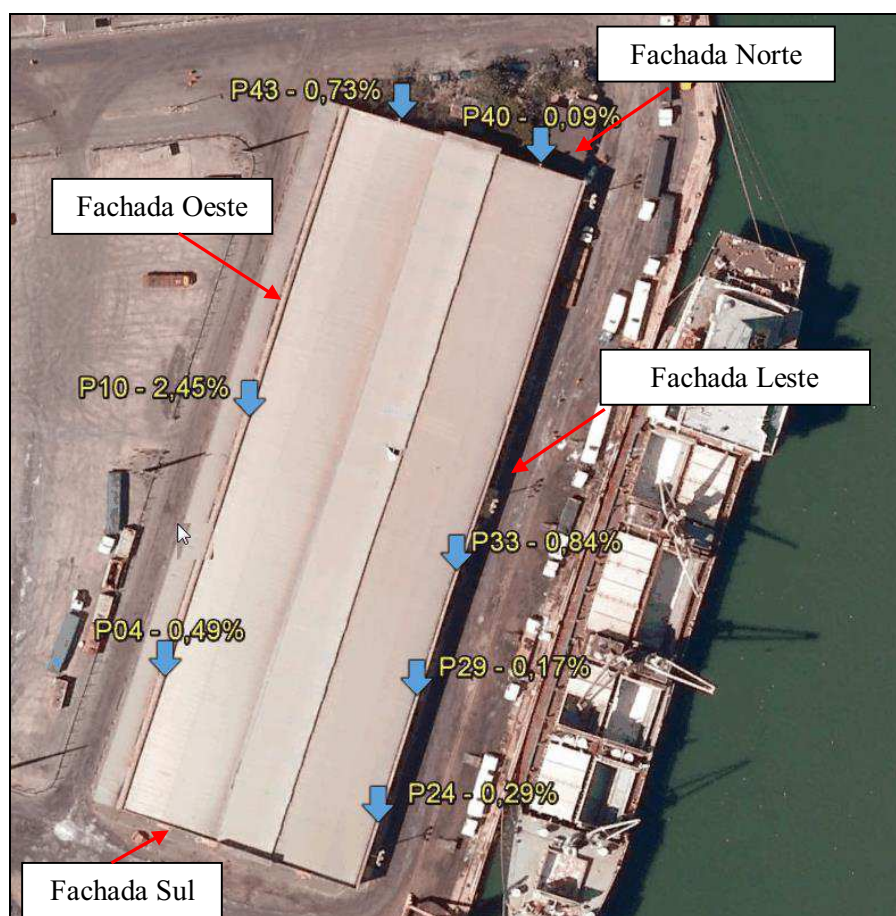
Posicionamento dos pilares e resultado do ensaio de teor de cloretos em relação à massa de cimento.
